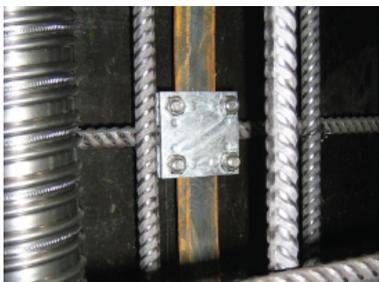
Verbindung Blitzschutzzeisen mit Bewehrung
